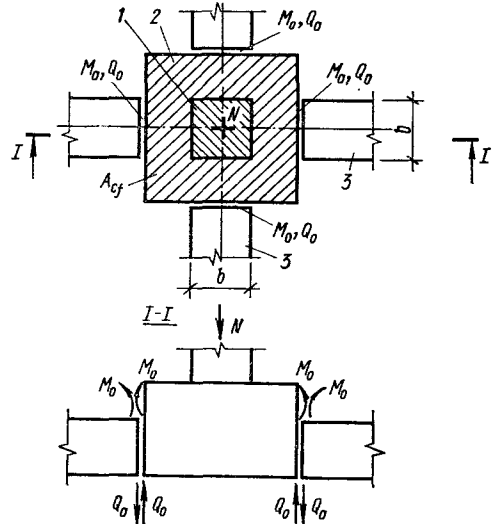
К расчету перекрестного ленточного фундамента:
